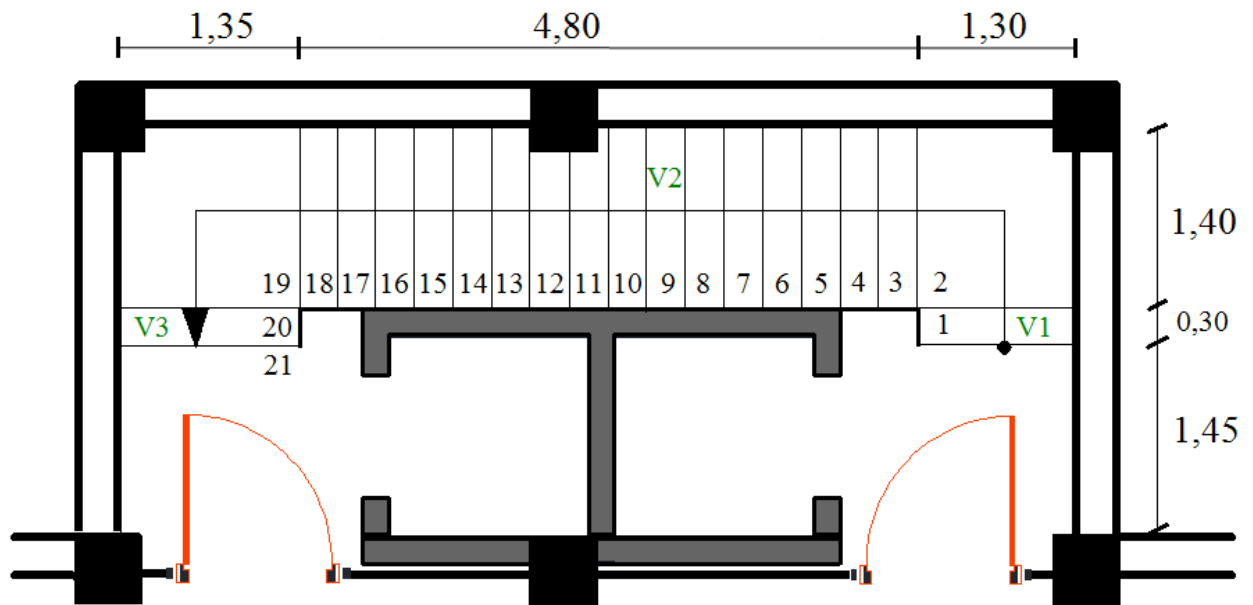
vue en plan de l'escalier RDC (type2).
